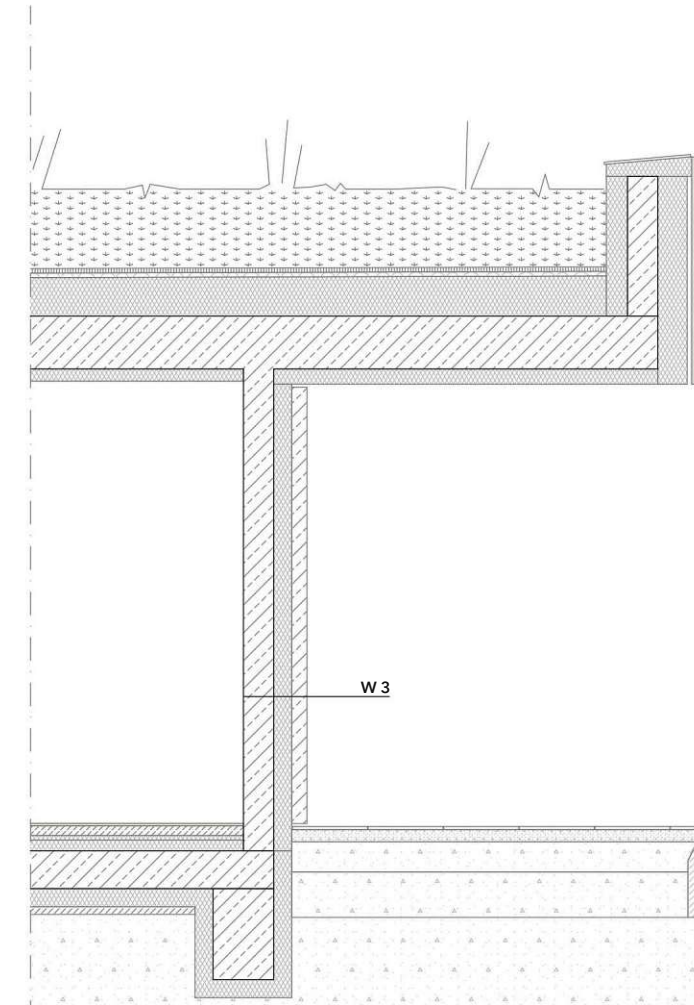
Fassadenschnitt 1:50 Hauptgebäude Kindergarten Sichtbetonwand
